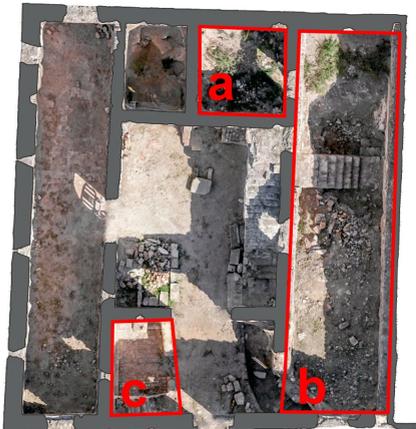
Identificación de los tres espacios de la planta baja del castillo donde se han construido las bóvedas tabicadas (Autores: Vegas y Mileto).
